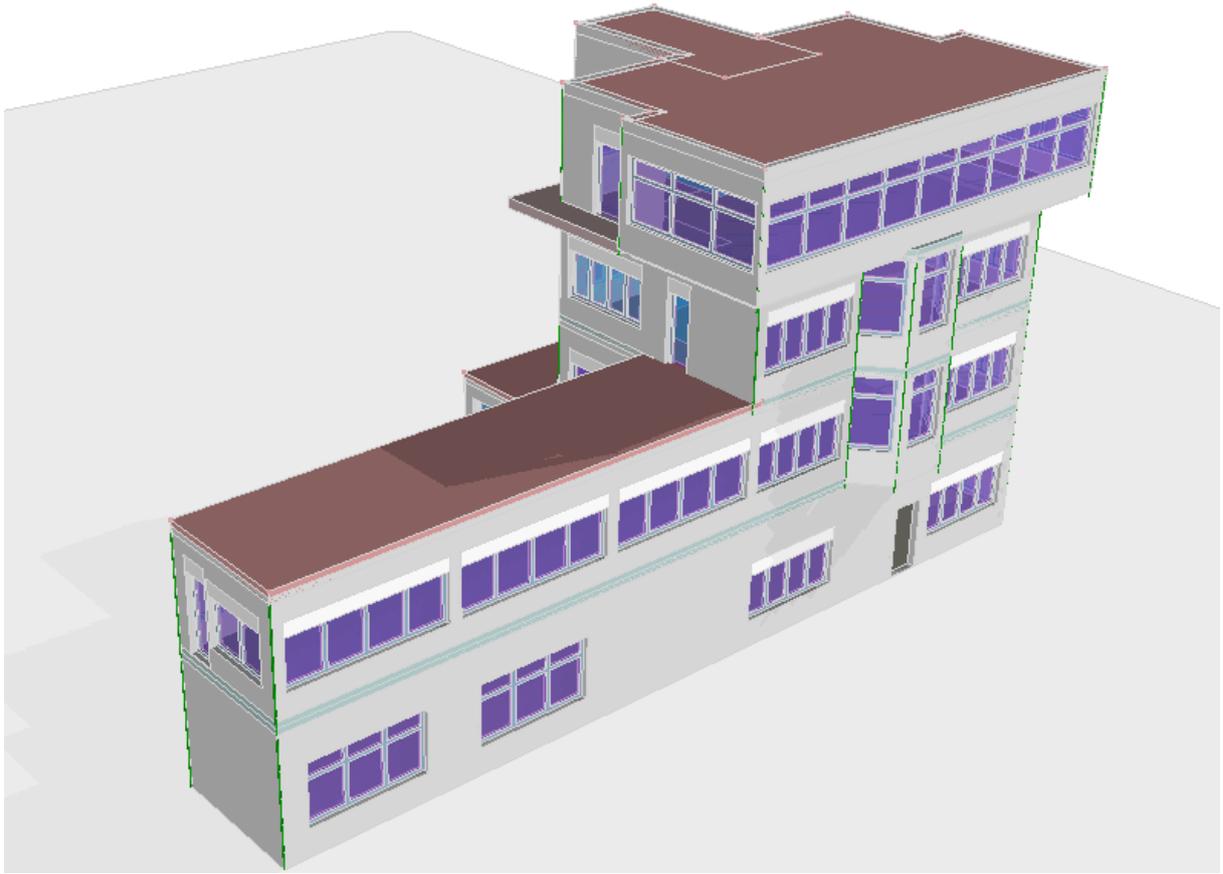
modello 3D. Prospetto su ingresso principale (lato pista)
